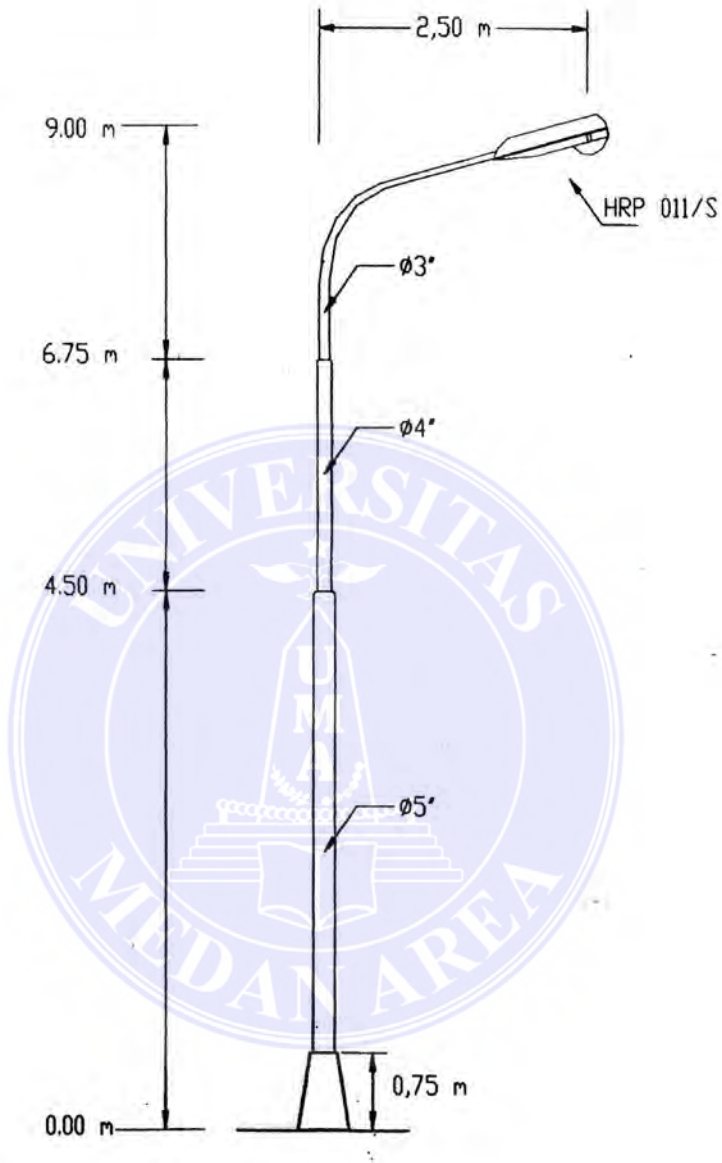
Instalasi penerangan pada jalan SM Raja dengan susunan lampu central twin bracket
